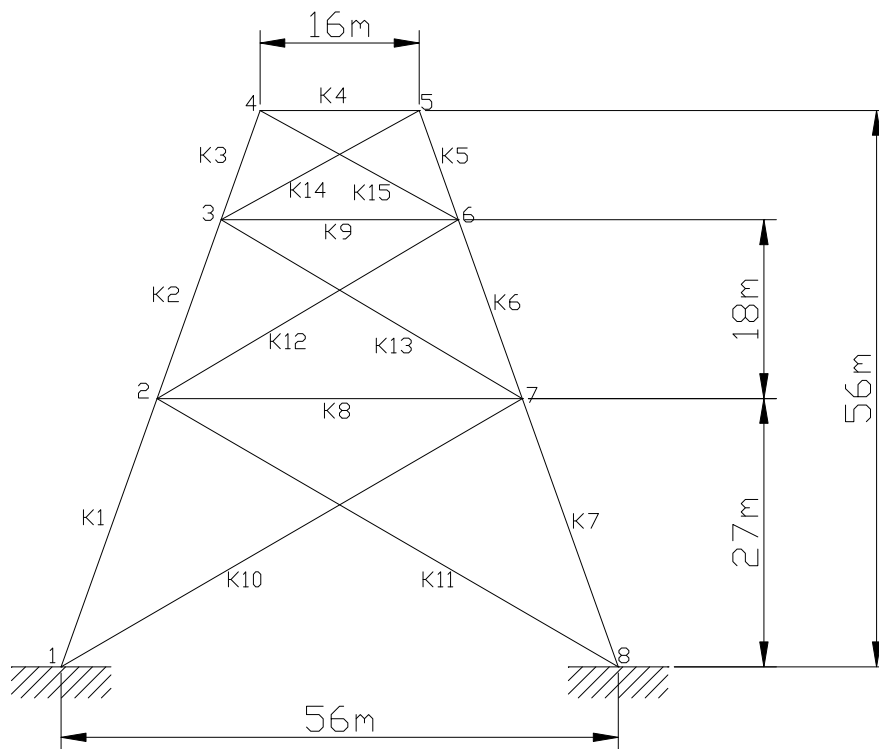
Dimensions géométriques du problème de la plate-forme
